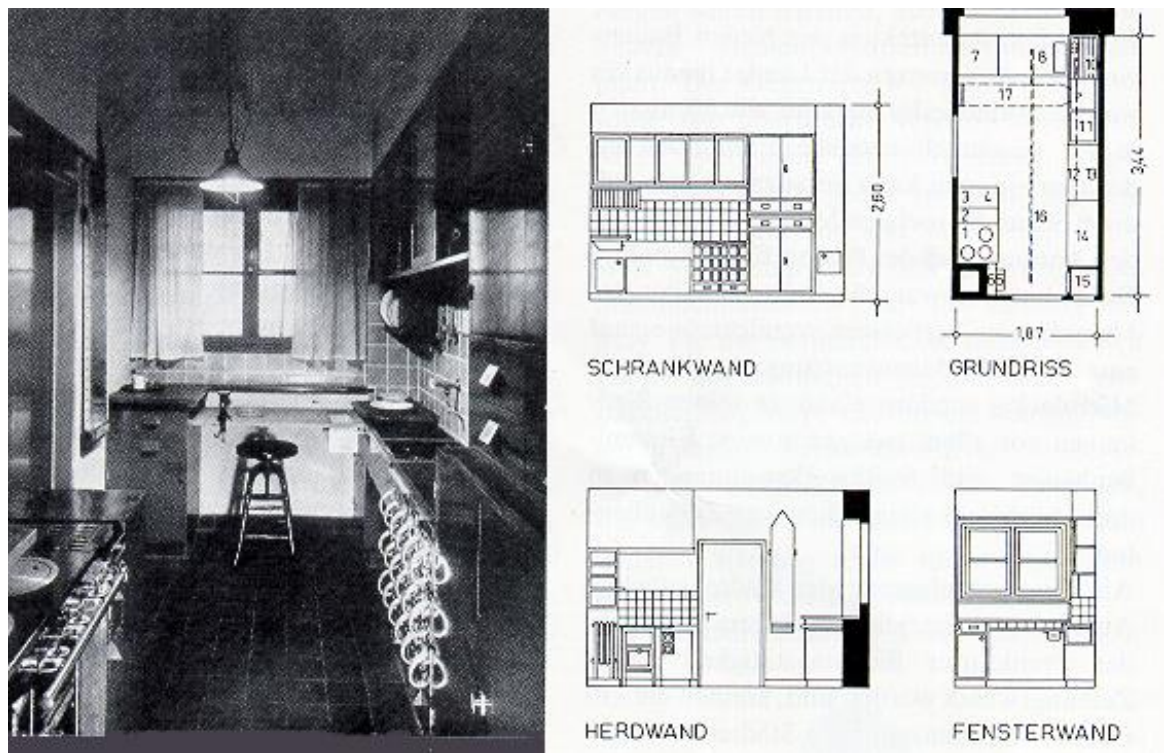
Cozinha de Frankfurt (Ungers 1983:70): Vistas das paredes do armário, fogão e janela; planta.
